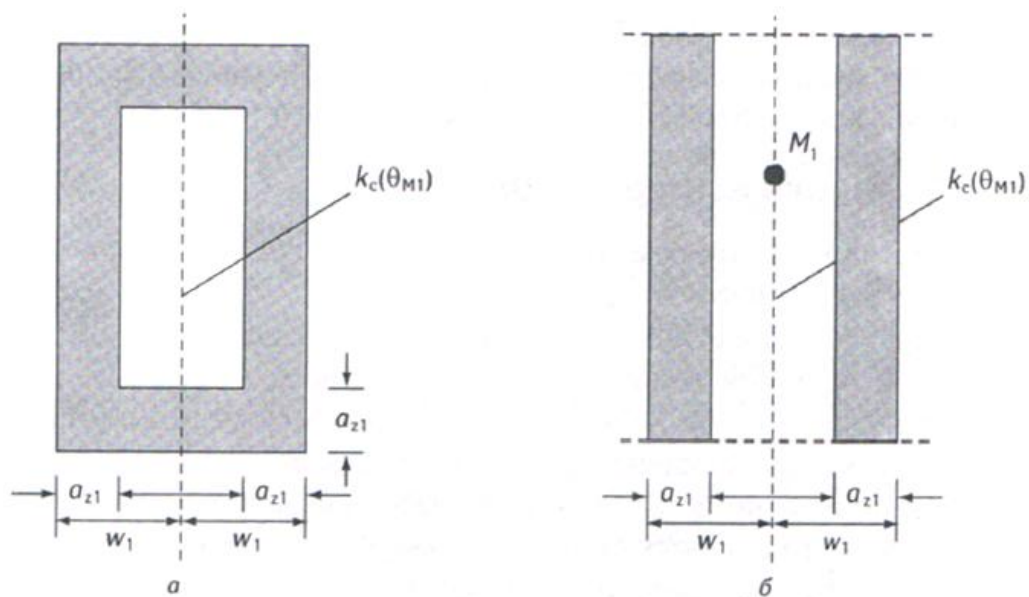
Визначення зменшеного поперечного перерізу бетону для залізобетонних плит: а - поперечний переріз колони; б - еквівалентна стіна.
